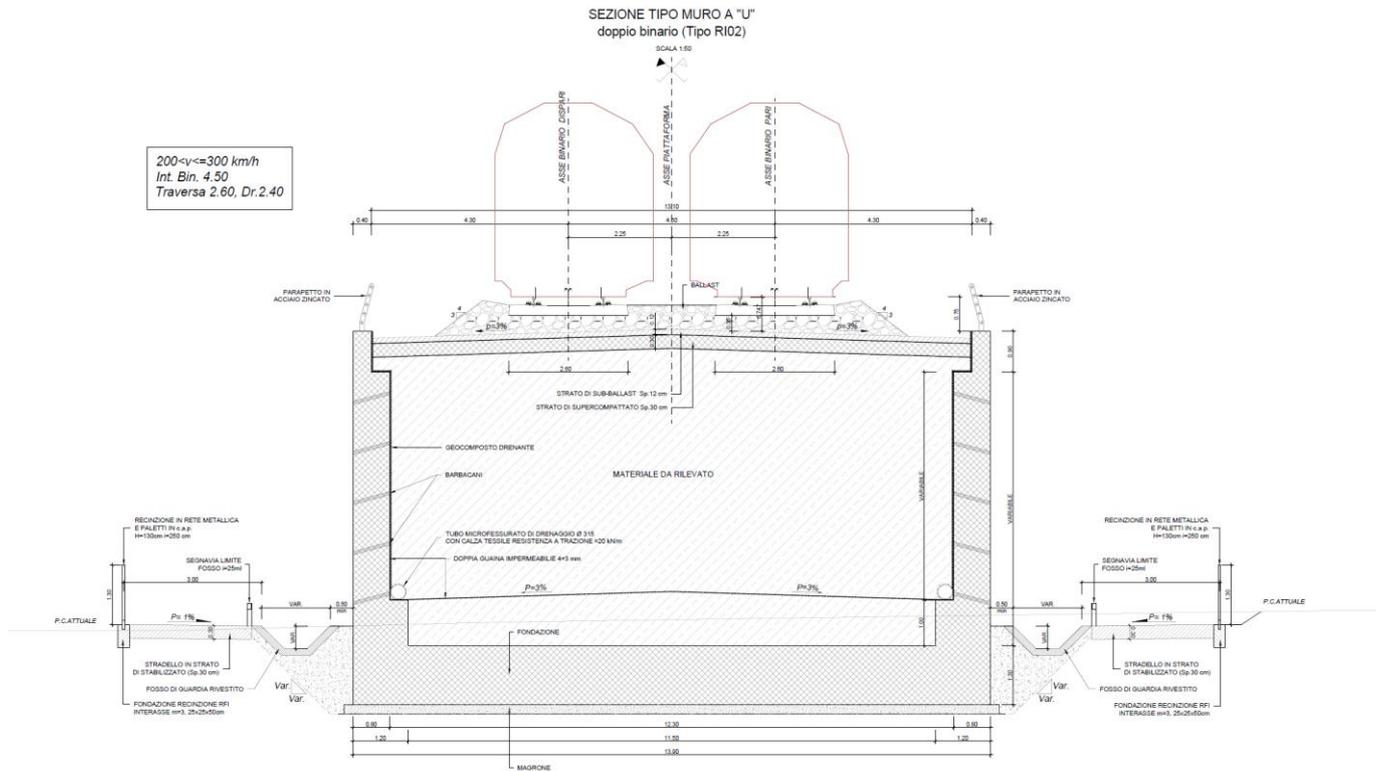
Sezione tipo in rilevato con muro a U a doppio binario
